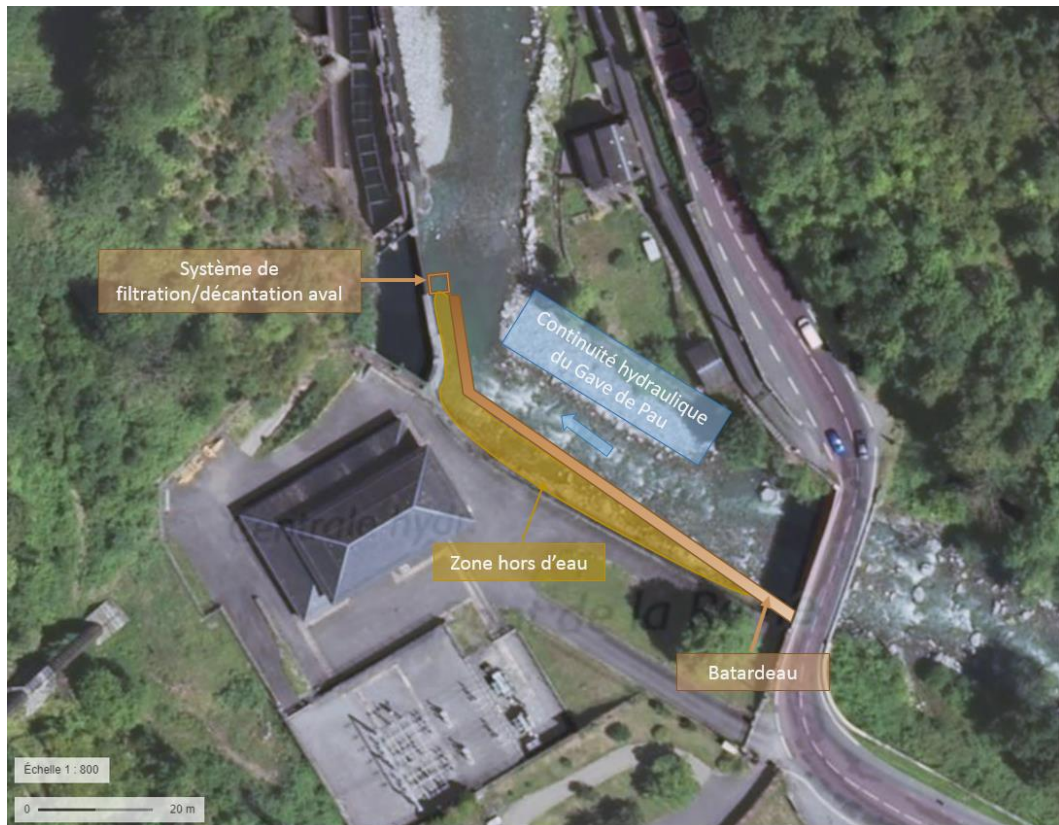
Schéma de principe de l'isolement hydraulique sur le site de Pont de la Reine
